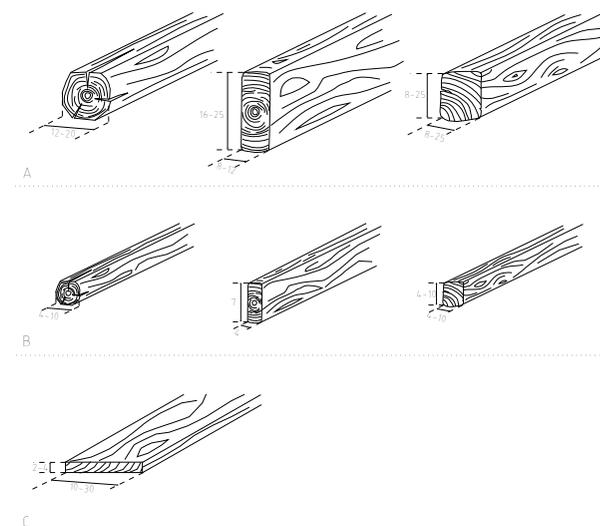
Sezioni degli elementi lignei tipo: A. travi (a sezione pseudo-circolare, a sezione rettangolare, a sezione quadrata); B. listelli (detti *fucètti*, a sezione pseudo circolare, a sezione rettangolare, a sezione quadrata); C. tavole. Elaborazione dell'autore.
